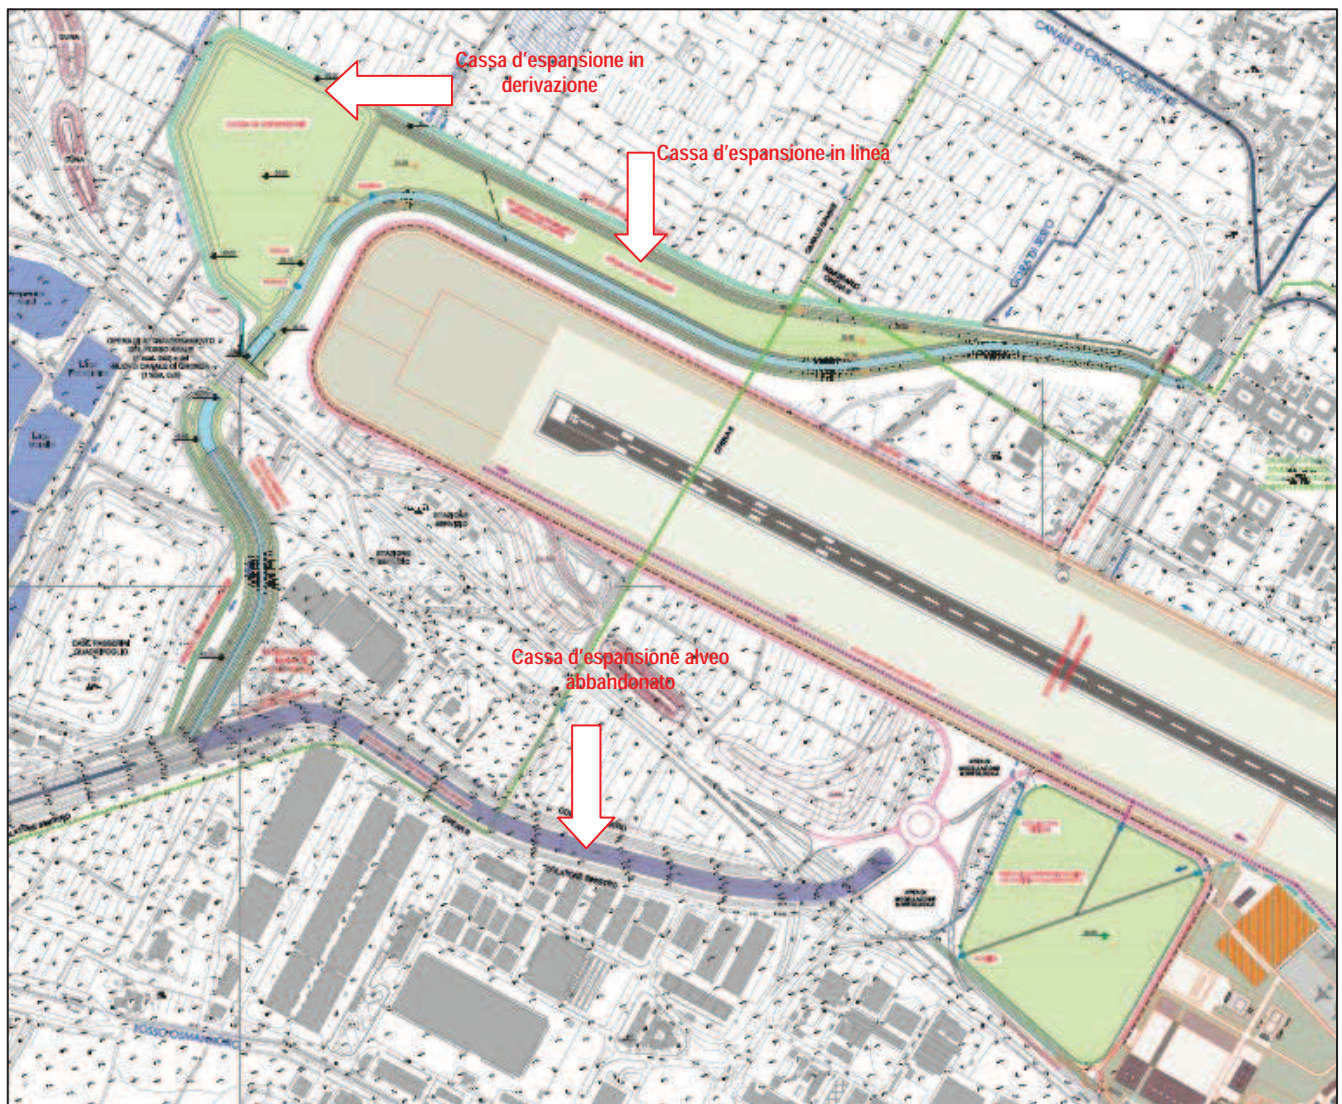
Stralcio planimetrico interventi di sistemazione idraulica del Fosso reale
